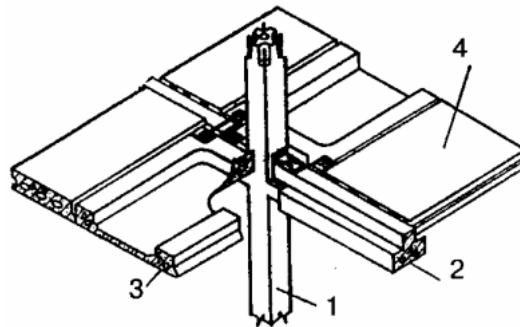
Фрагмент кріплення плитного перекриття в каркасно-панельній системі П-04: 1 – колона; 2 – ригель; 3 – зв'язкова санітарно-технічна панель; 4 – панель перекриття
